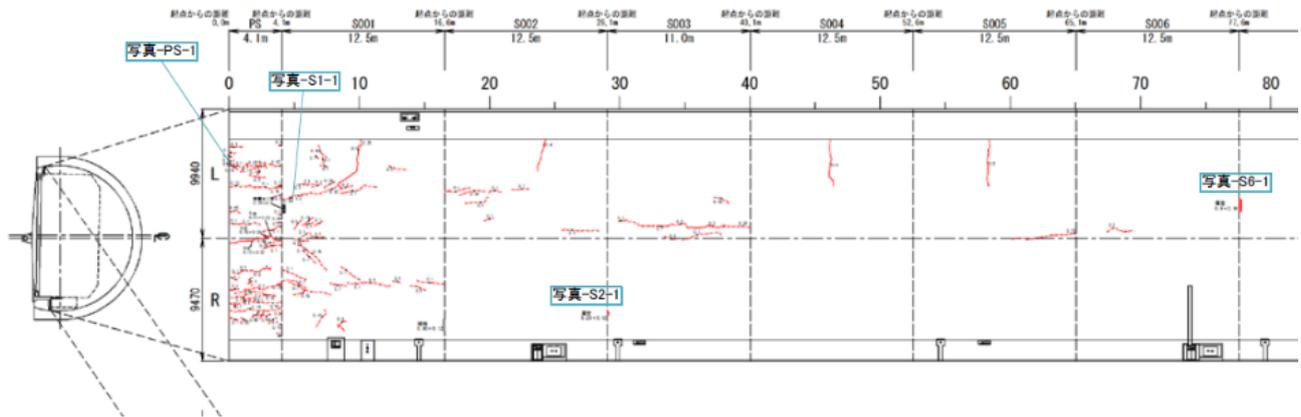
定期点検時の覆工コンクリートのひび割れ図の例
